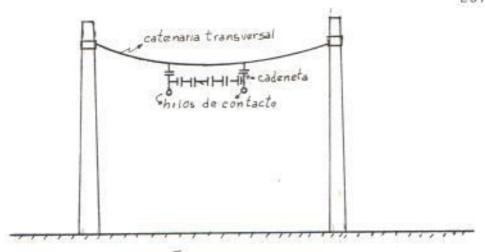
SOPORTE TIPO PORTICO
